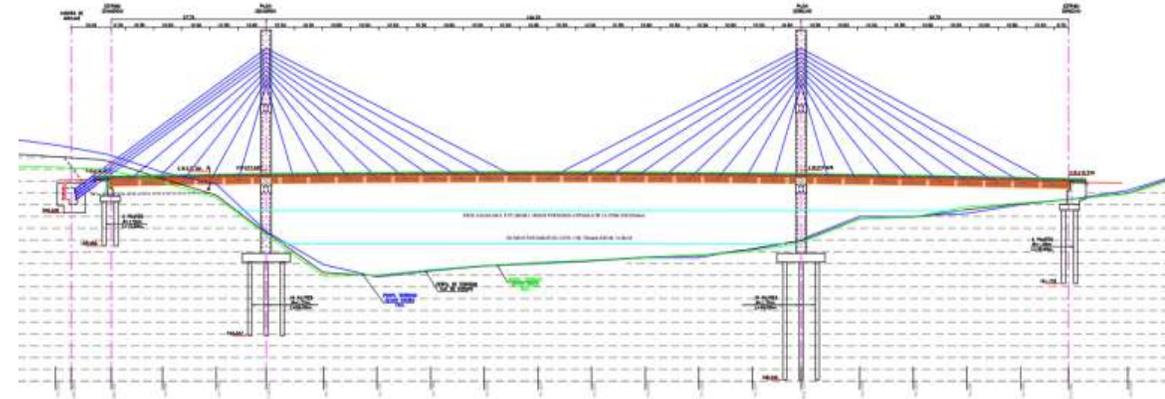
Vista en elevación de Puente Atirantado Cabo Leveau
